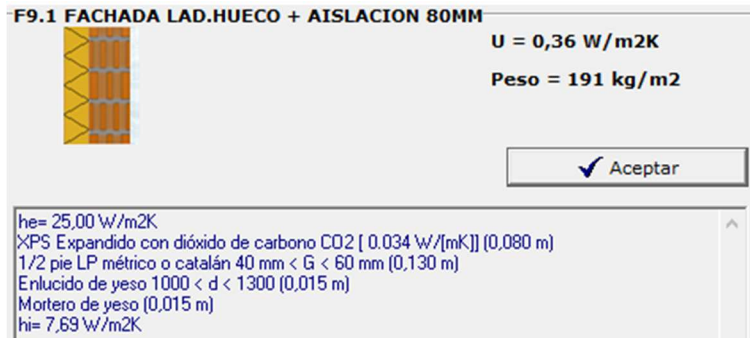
Detalle constructivo de muros con aislamiento térmico exterior. Elaboración propia
